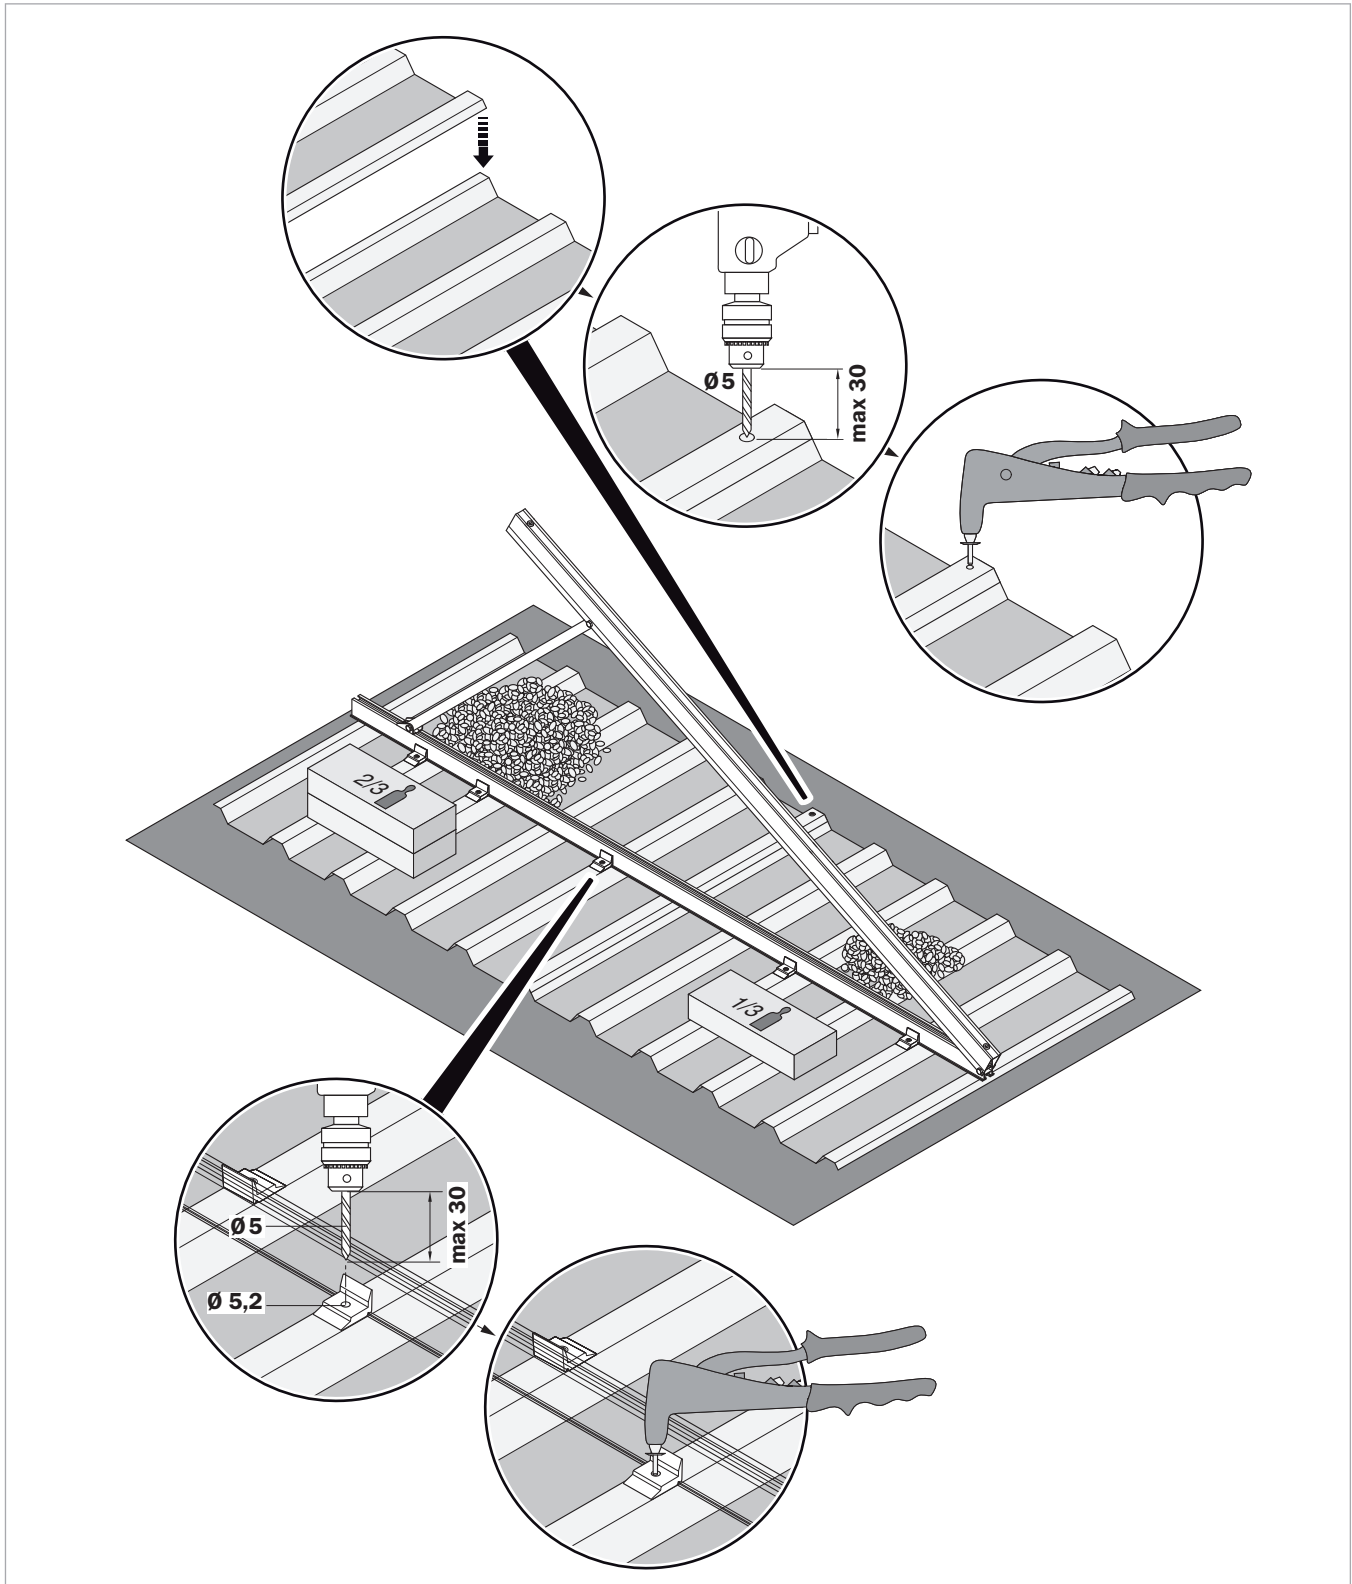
Montage des Flachdachständers auf Trapezblech, mit Trapezblechsatz
